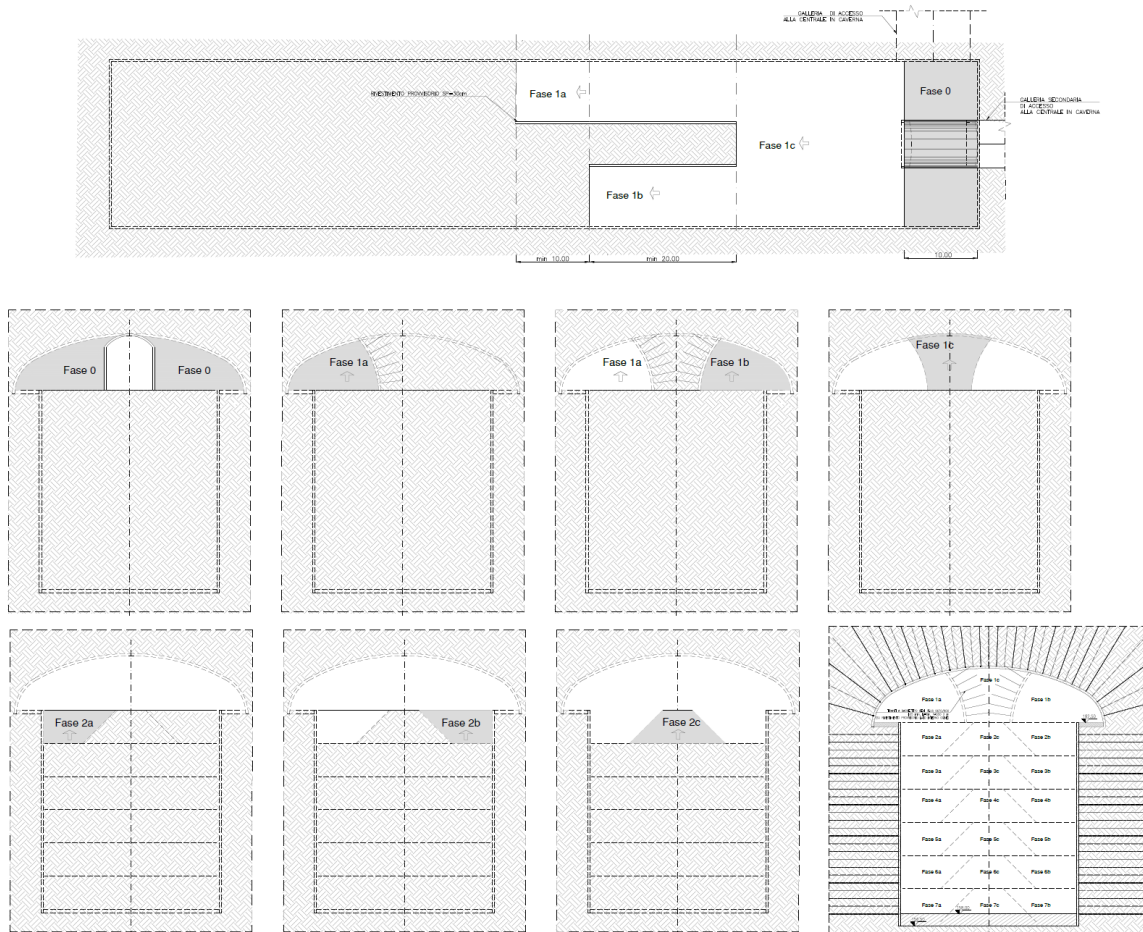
Fasi di scavo della Centrale in Caverna, planimetria e sezione trasversale
